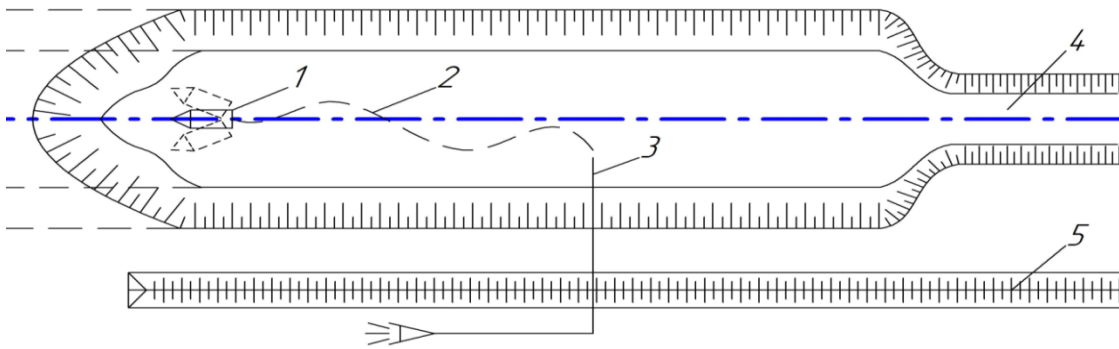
Схема разработки узкопрофильных каналов малогабаритными землесосными снарядами:
